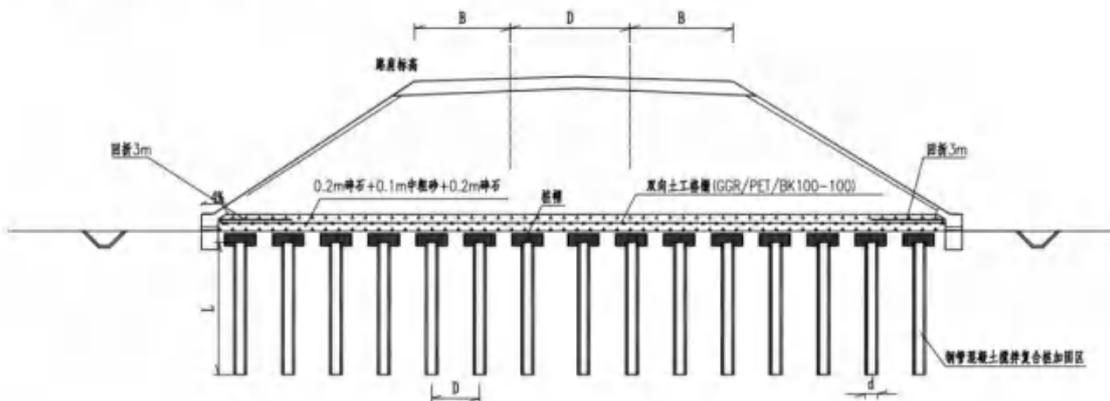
钢管混凝土搅拌复合桩加固区断面设计图
